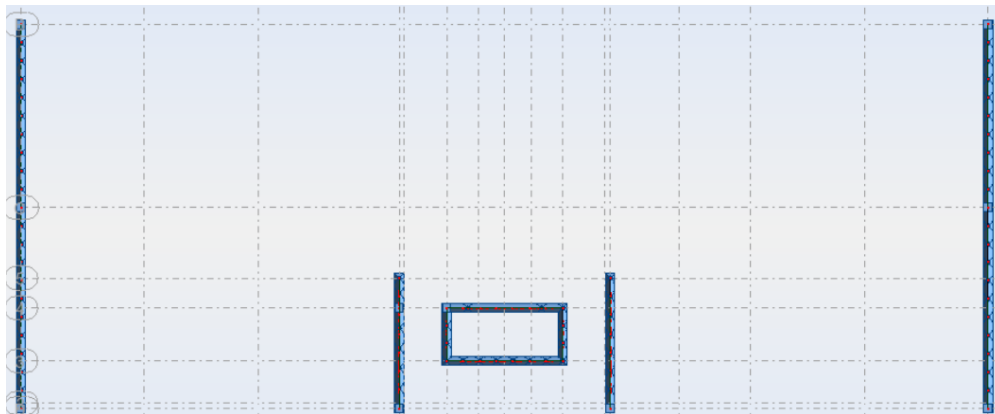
La 1^{ère} disposition des murs voiles et poteaux
